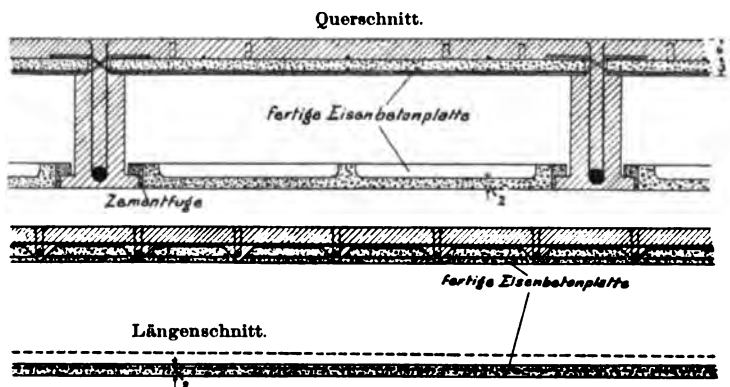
Herstellung einer Decke mit ebener Untersicht. Benutzung dünner Eisenbetonplatten als Schalung für die obere Decke.
